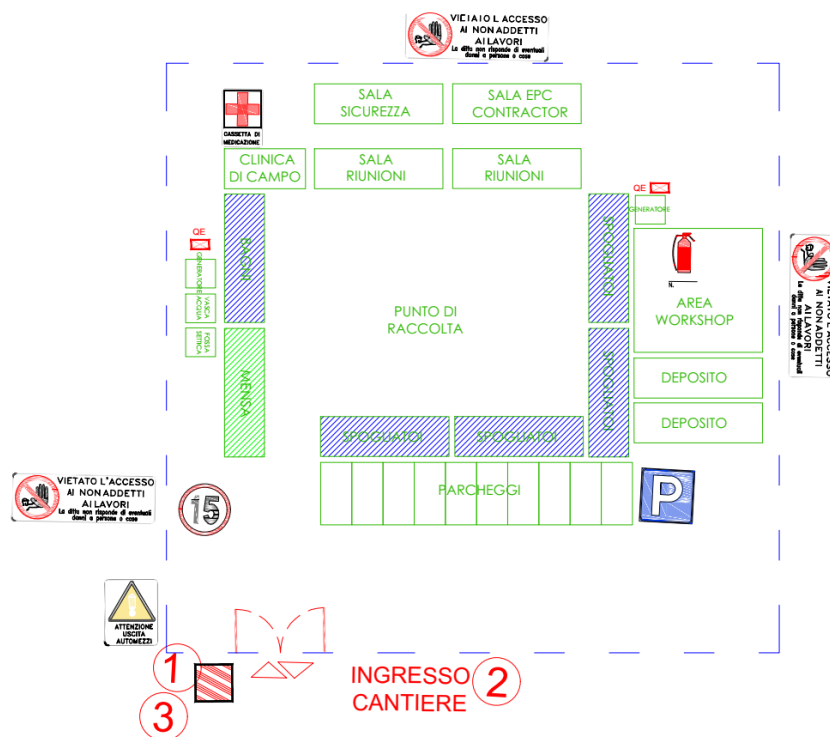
Planimetria area di cantiere (estratto di PRO_TAV_27)
